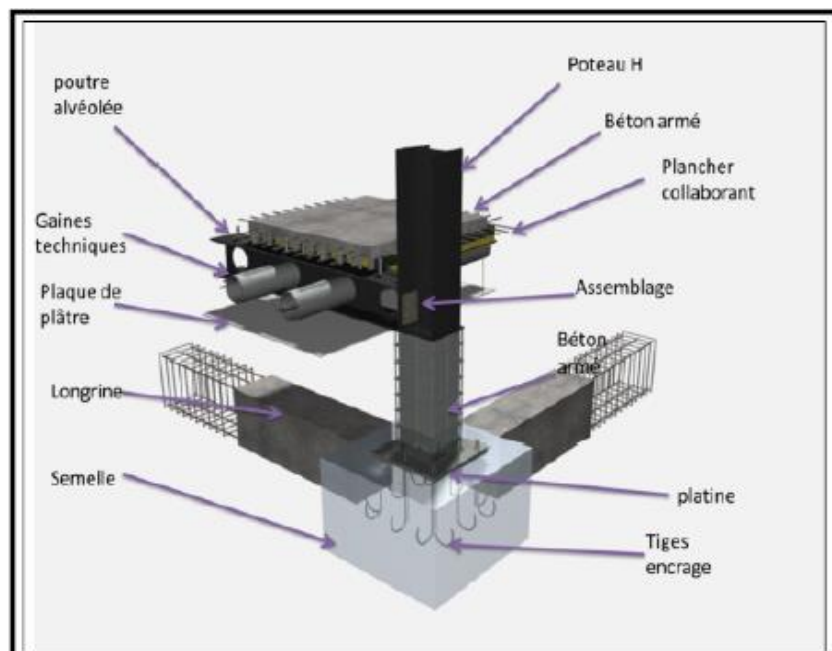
Détail de l'assemblage poteaux poutre planché.
